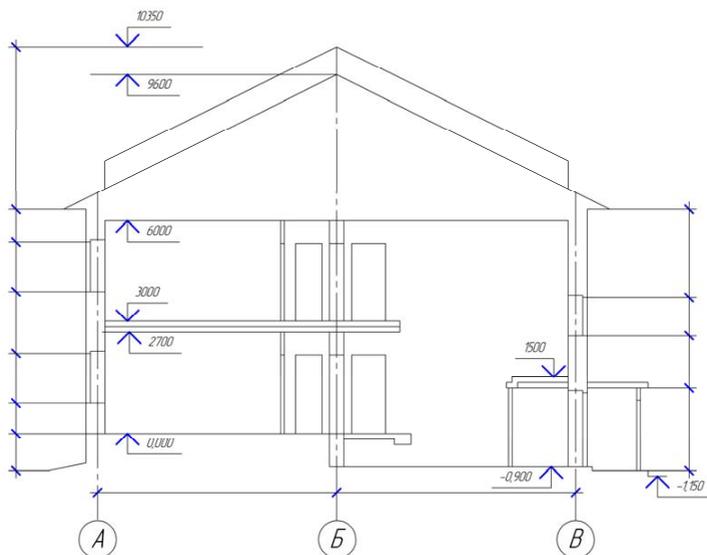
Вычерчивание перекрытий, оконных и дверных проемов
